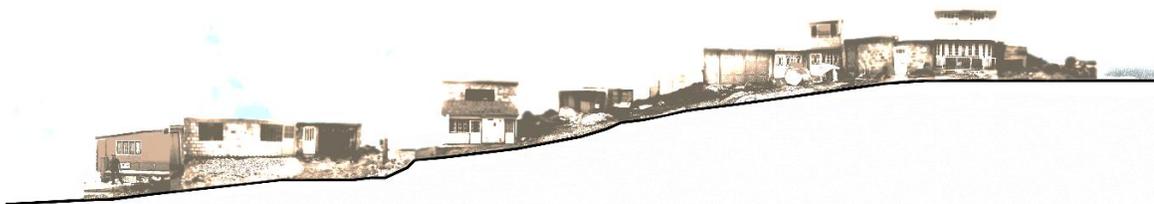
Perfil Urbano de Intervención. Imagen del lugar en donde se encuentra una de las zonas de intervención del barrio. Elaboración Propia.
